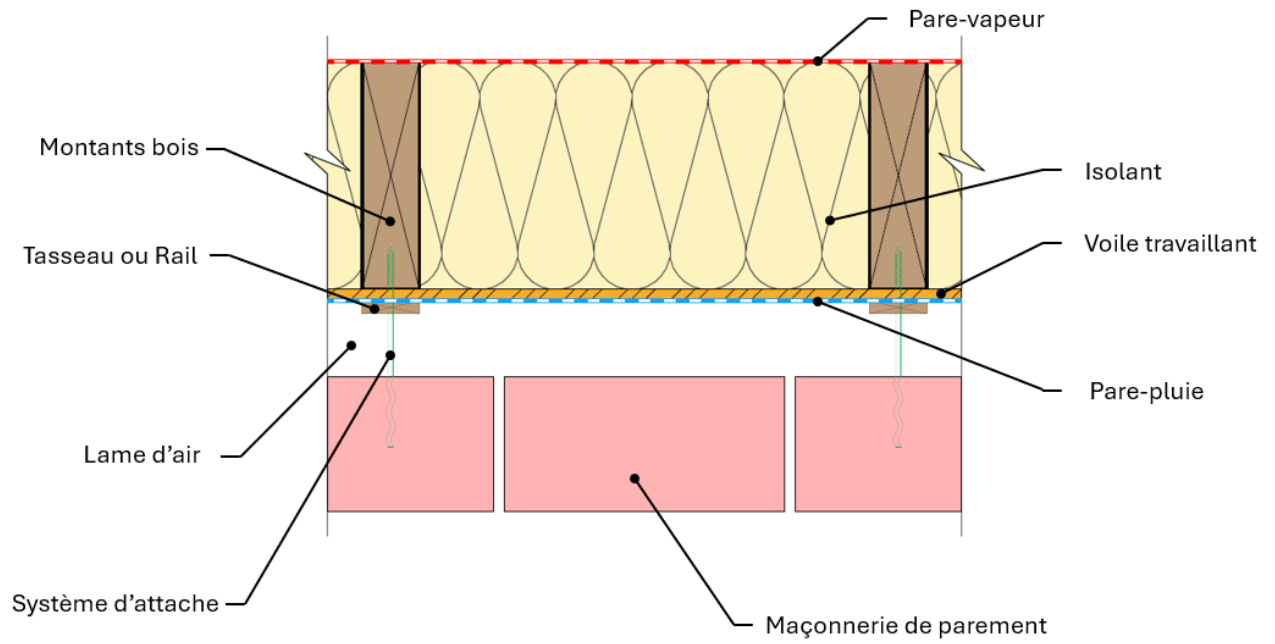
Coupe horizontale d'un mur double maçonnerie sur ossature bois
